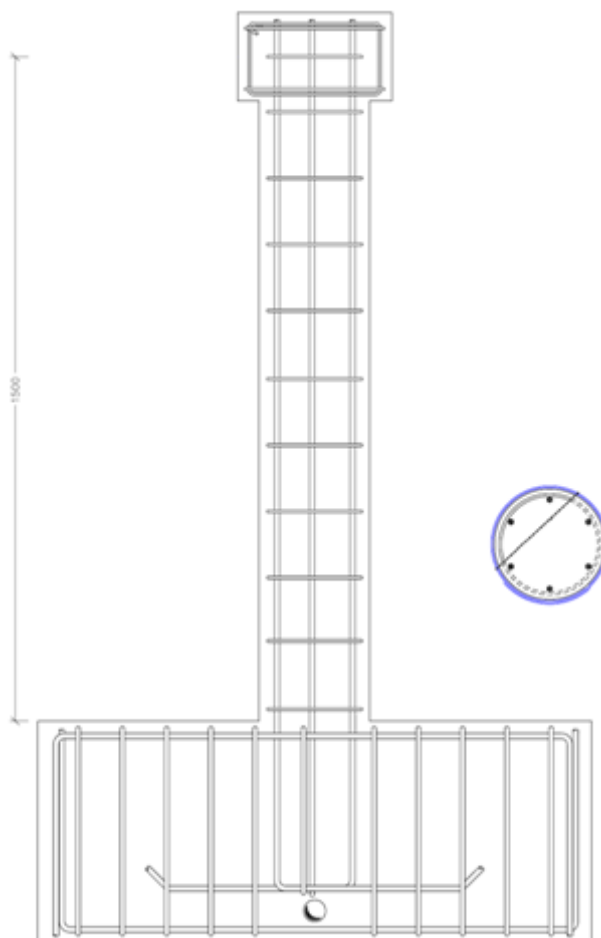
Pormenorização das armaduras do pilar (adaptado [7])
